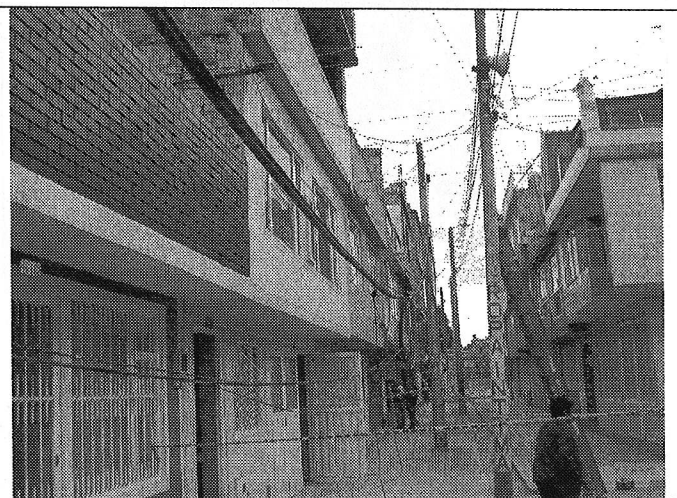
Vista general de la Carrera 45 D, se observa la vía peatonal y la tipología de las viviendas en el Sector Catastral de la Calle 59 A sur.
